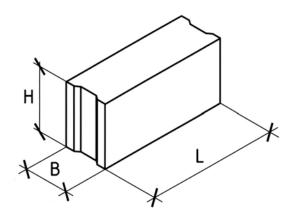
Фундаментный блок бетонный для стен подвалов
